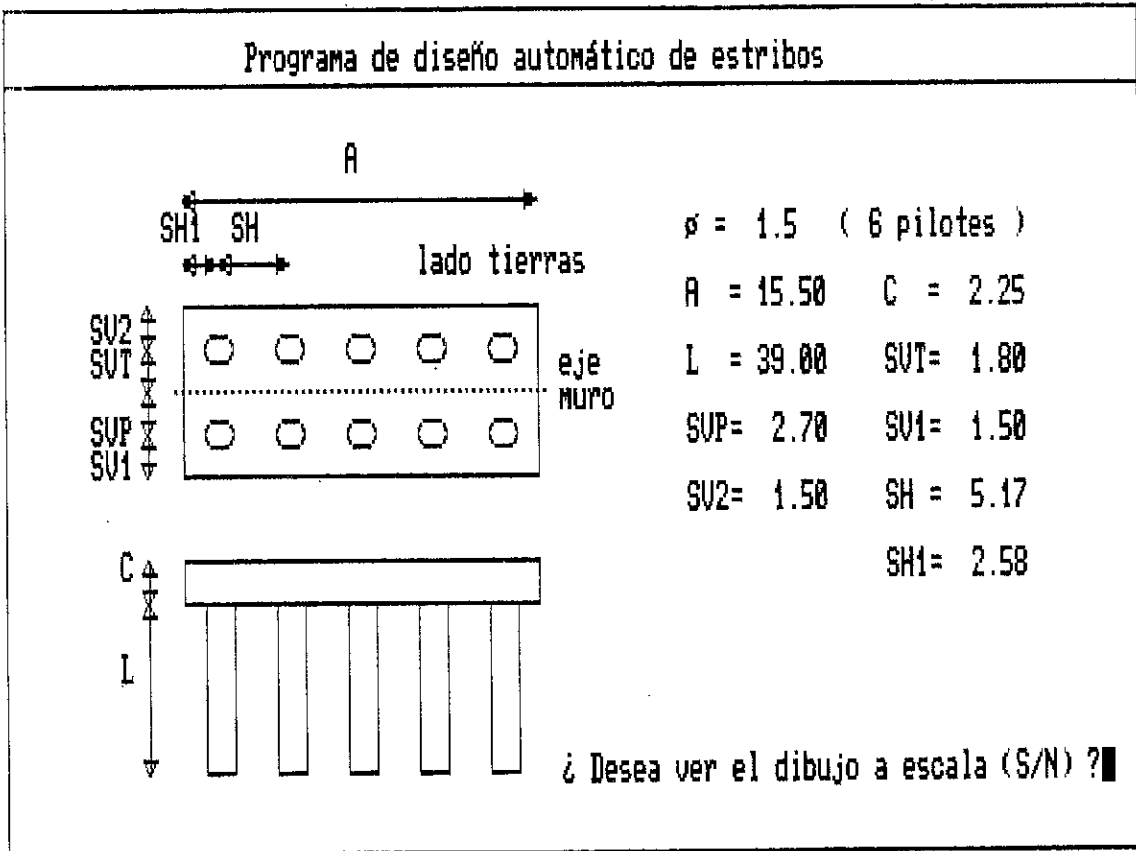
Salida de la geometría de la cimentación profunda correspondiente al terreno tipo arena.
